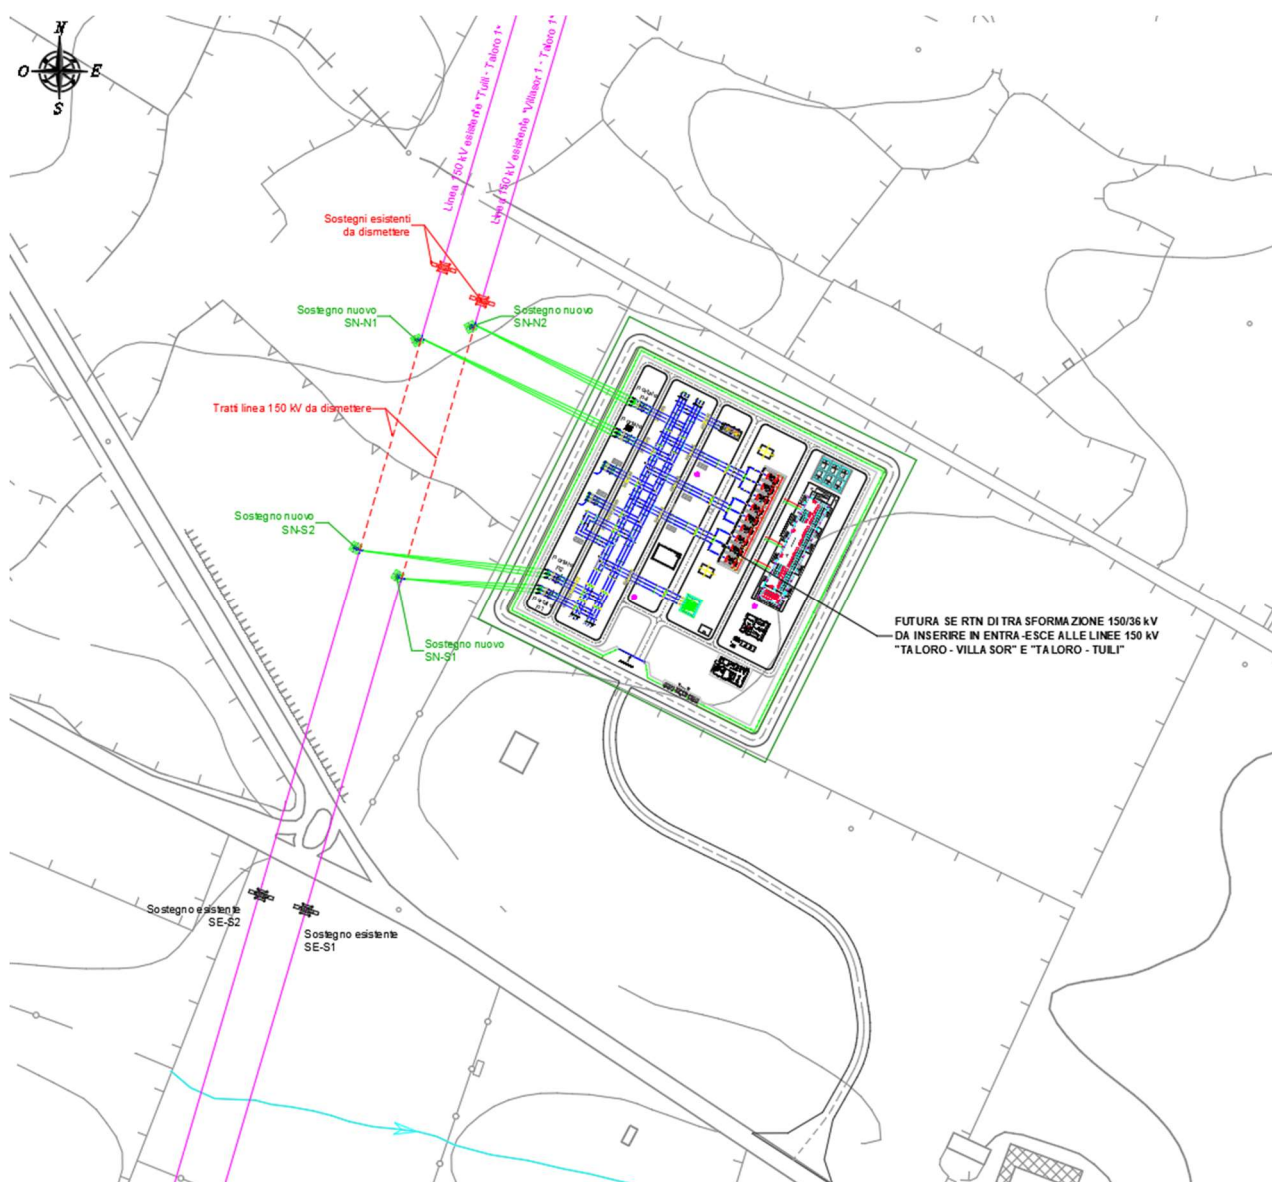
Disposizione planimetrica raccordi linee 150 kV "Taloro – Villasor" e "Taloro – Tuili"
